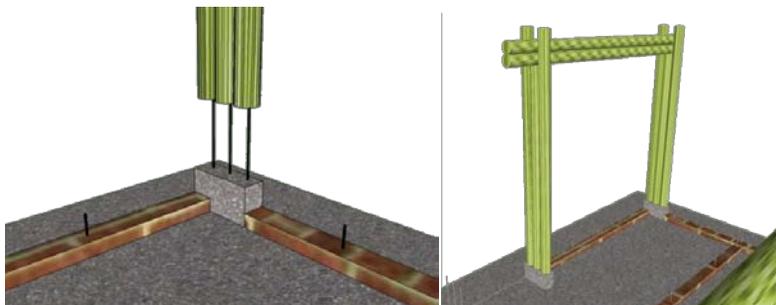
Encaixe das colunas com a fundação e módulo estrutural com coluna de reforço
